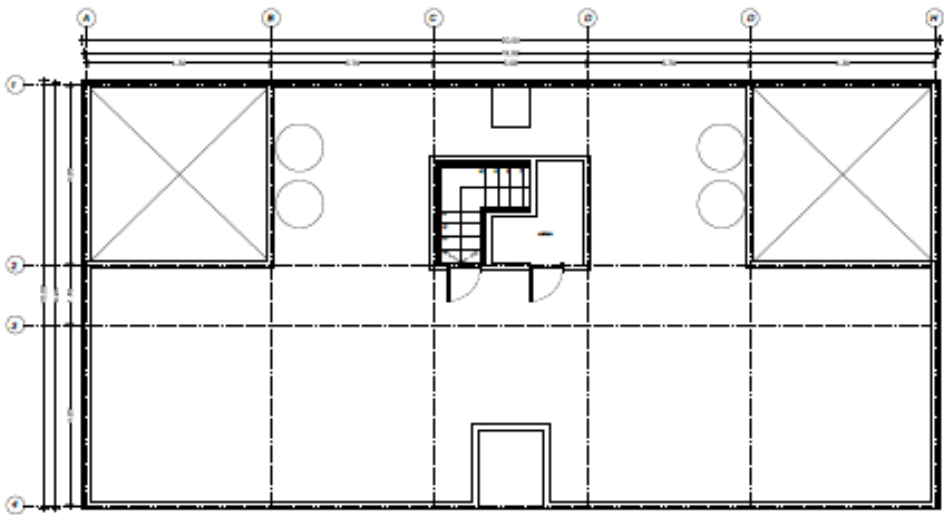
Planta baja del proyecto arquitectónico. Autoría propia.
